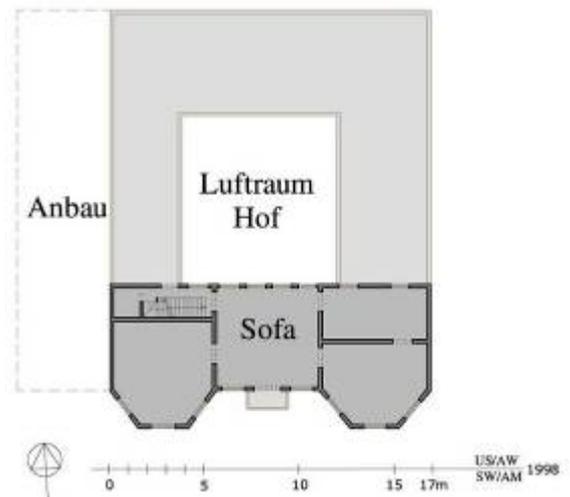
Haus Kat.-Nr. XXIV/4-811, Grundriss OG
